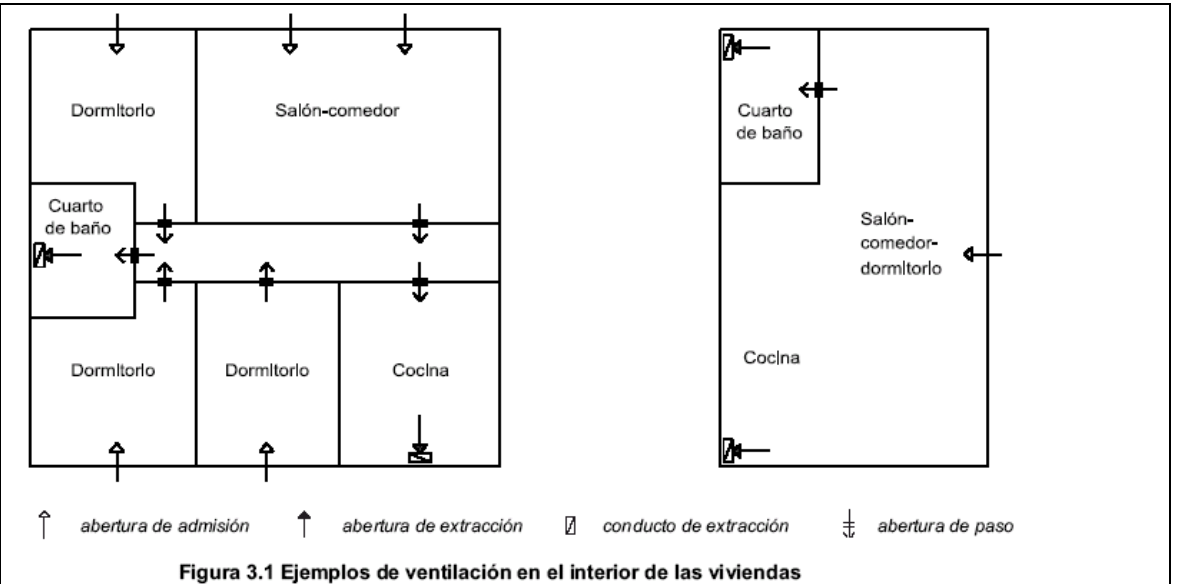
Ejemplos de ventilación en el interior de las viviendas
